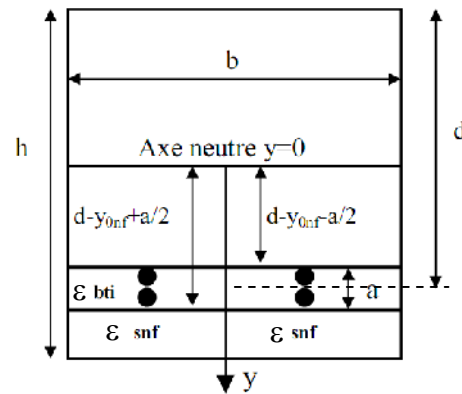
Section non fissurée d'une poutre, avec les déformations (ϵ_{snf} , ϵ_{bti}).
